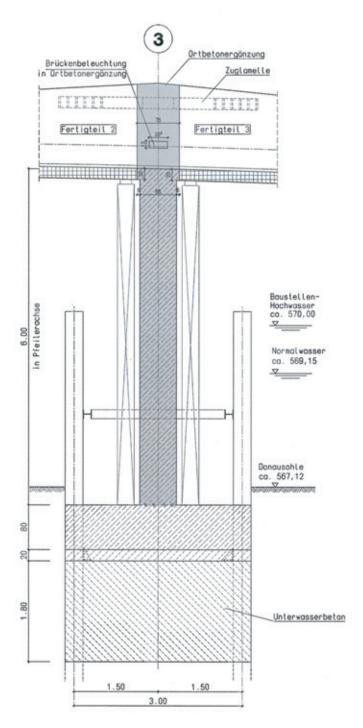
Längsschnitt Pfeilerbereich mit hervorgehobener Ortbetonergänzung Longitudinal section of pier area with highlighted in-situ concrete complement
